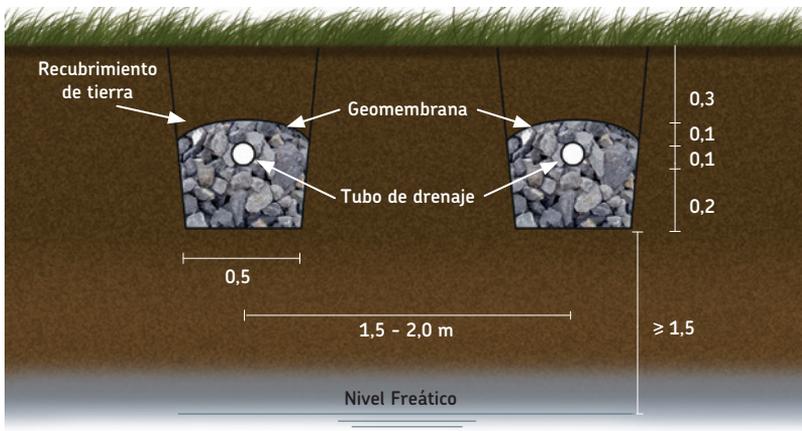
Detalles constructivos y dimensiones típicas de las zanjas de infiltración.
